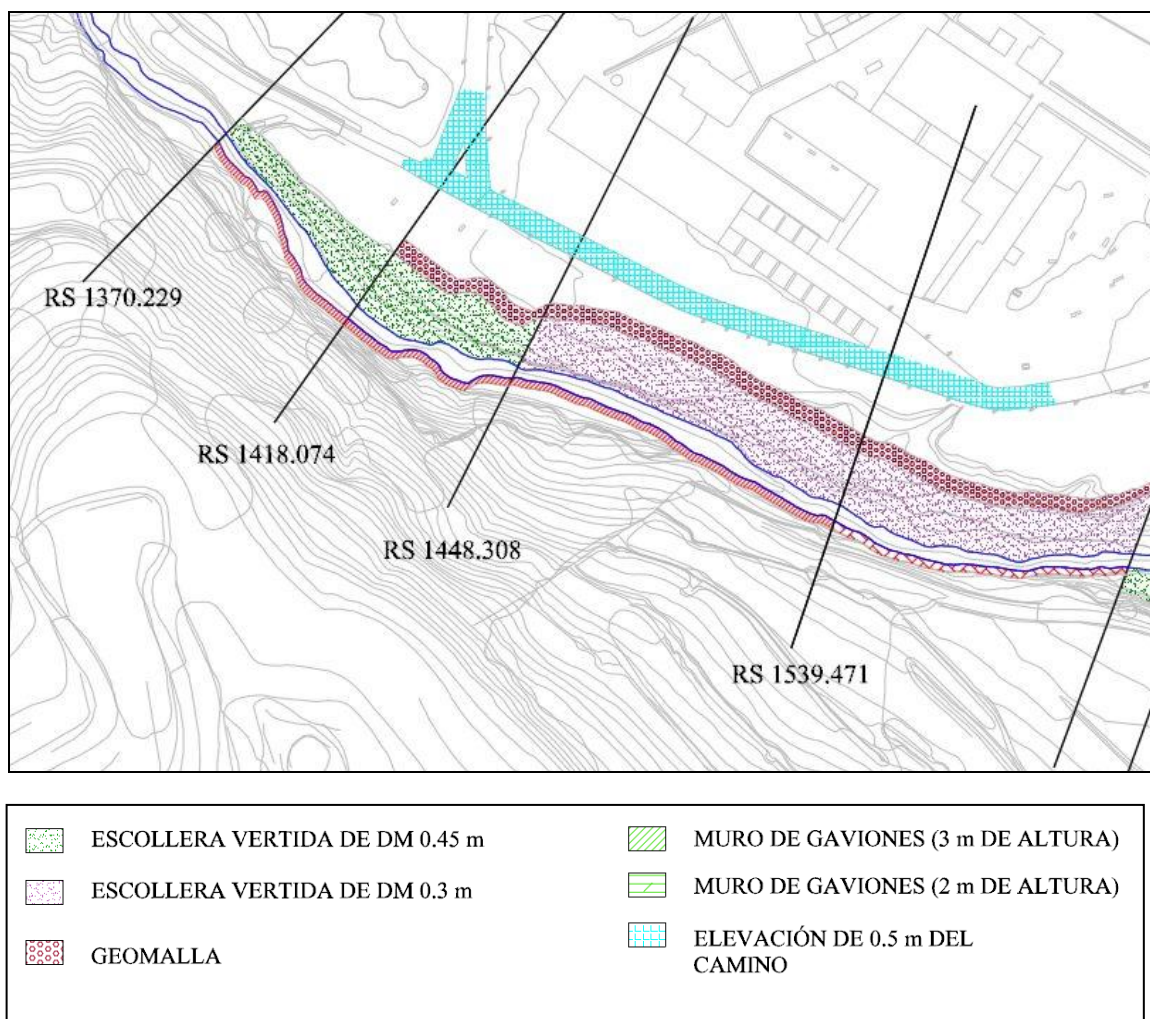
Planta de las actuaciones propuesta para el subtramo 1
